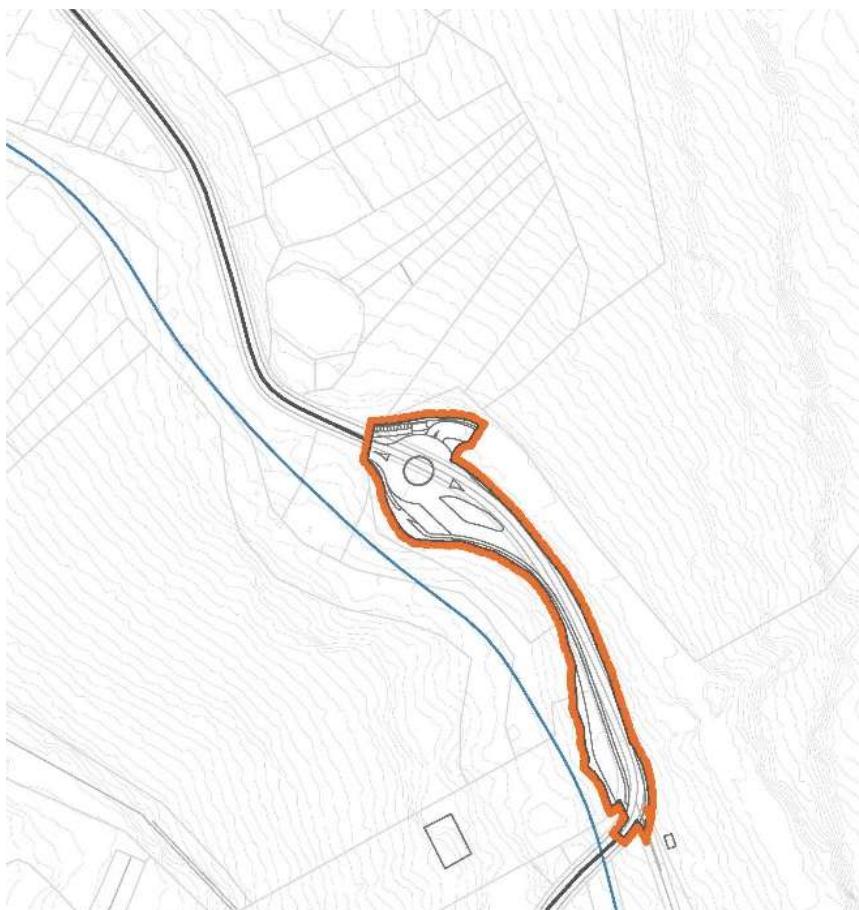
Detalle de rotonda en ámbito norte (alternativas 1 y 2).
